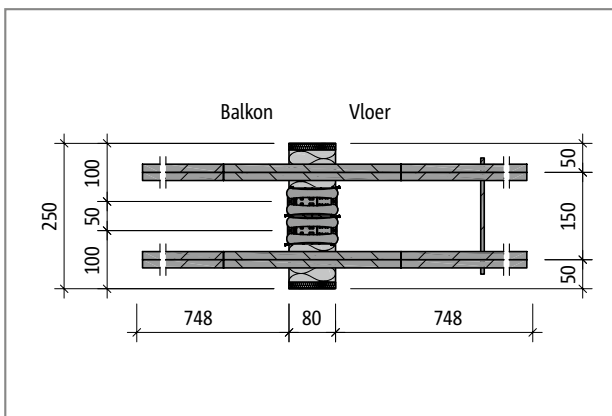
Schöck Isokorb® type Q-E-W-VV5: Bovenaanzicht
